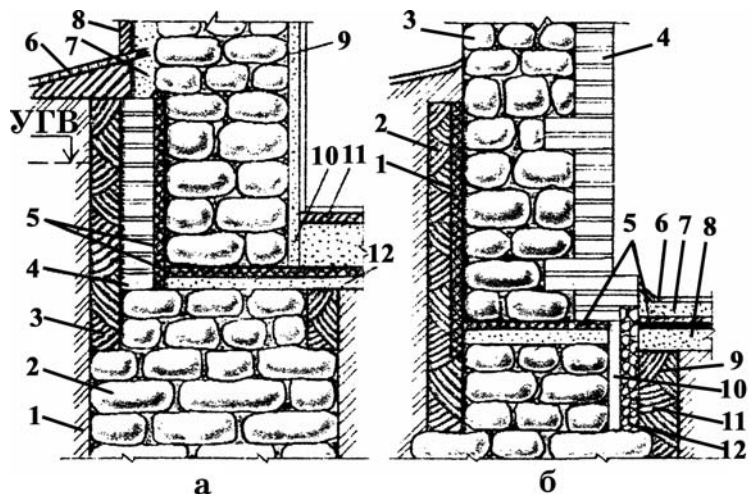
Гидроизоляция фундаментов: а — со стенами из бутовых камней: 1 — грунт основания; 2 — бутовые камни фундамента; 3 — глиняный замок; 4 — кирпич; 5 — вертикальная и горизонтальная гидроизоляции; 6 — отмостка; 7 — цементно-песчаный раствор; 8 — цоколь; 9 — штукатурка; 10, 12 — цементно-песчаная стяжка; 11 — пол; б — со стенами из кирпича: 1, 5 — вертикальная и горизонтальная гидроизоляции; 2, 9 — глиняный замок; 3 — бутовый камень; 4 — кирпич; 6 — покрытие пола; 7 — цементно-песчаная стяжка; 8 — бетонный слой по утрамбованному основанию; 10 — воздушная прослойка; 11 — грунт основания.
